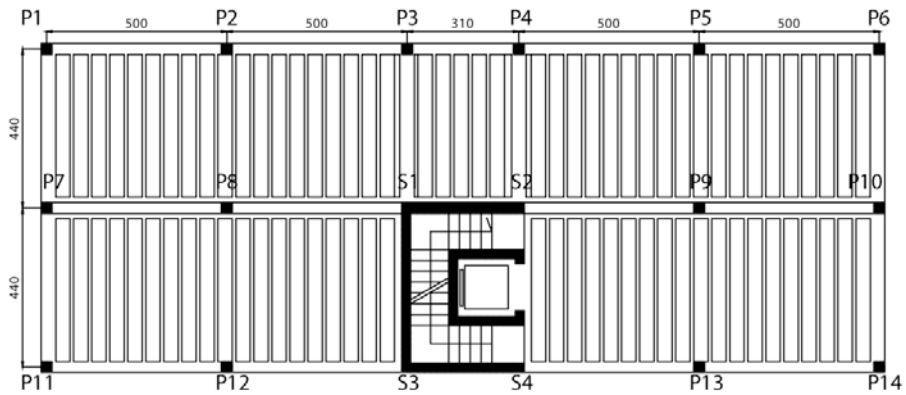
Pianta dell'impalcato piano tipo edificio
